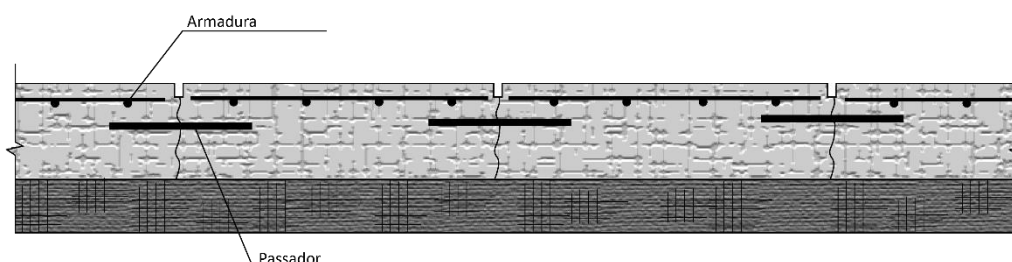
Perfil de pavimento rígido de betão armado, com juntas e passadores (adaptado de OLIVEIRA, 2000)
